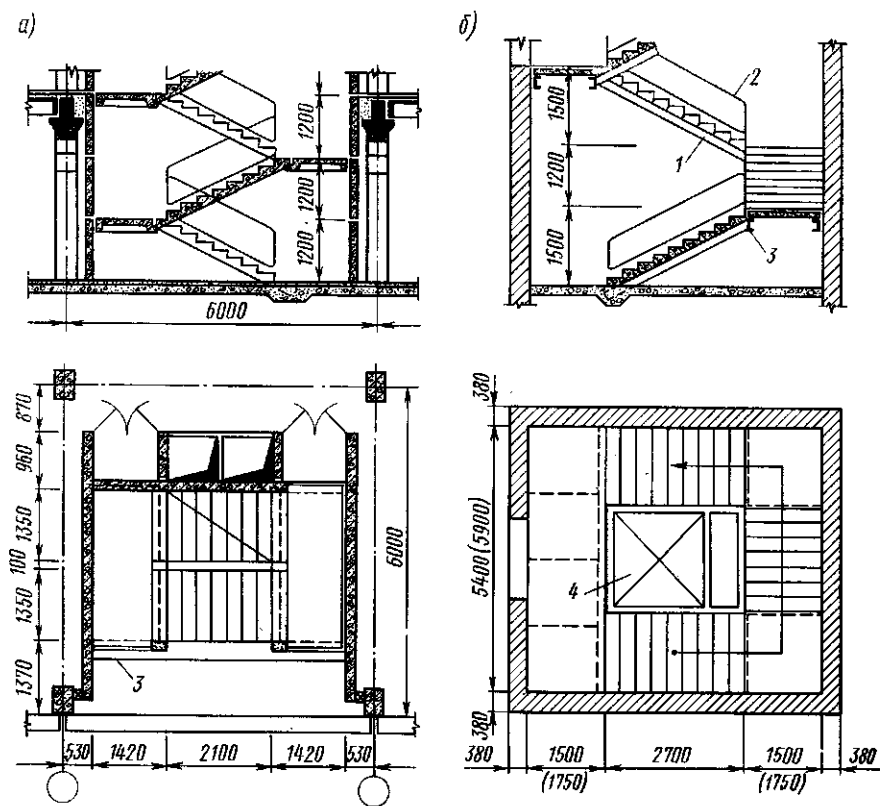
Основные лестницы многоэтажных зданий:
